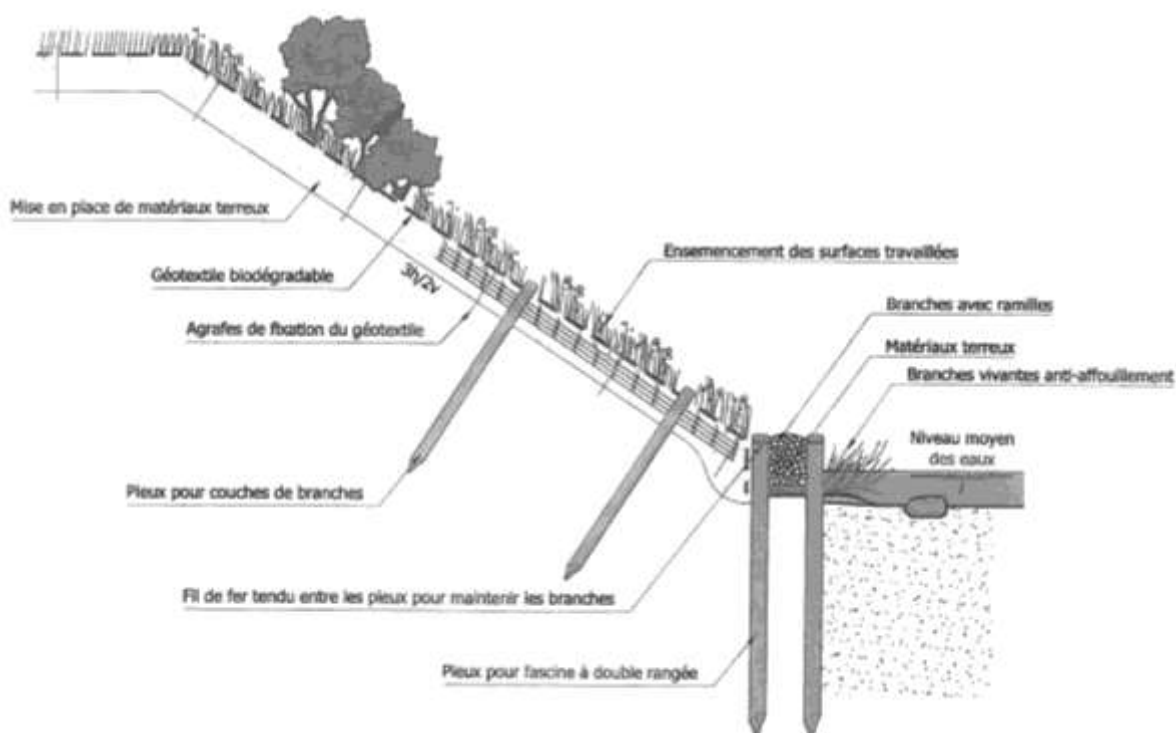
Profil en travers d'une fascine de saules consolidée par un tapis de branches (SILENE BIOTEC)
